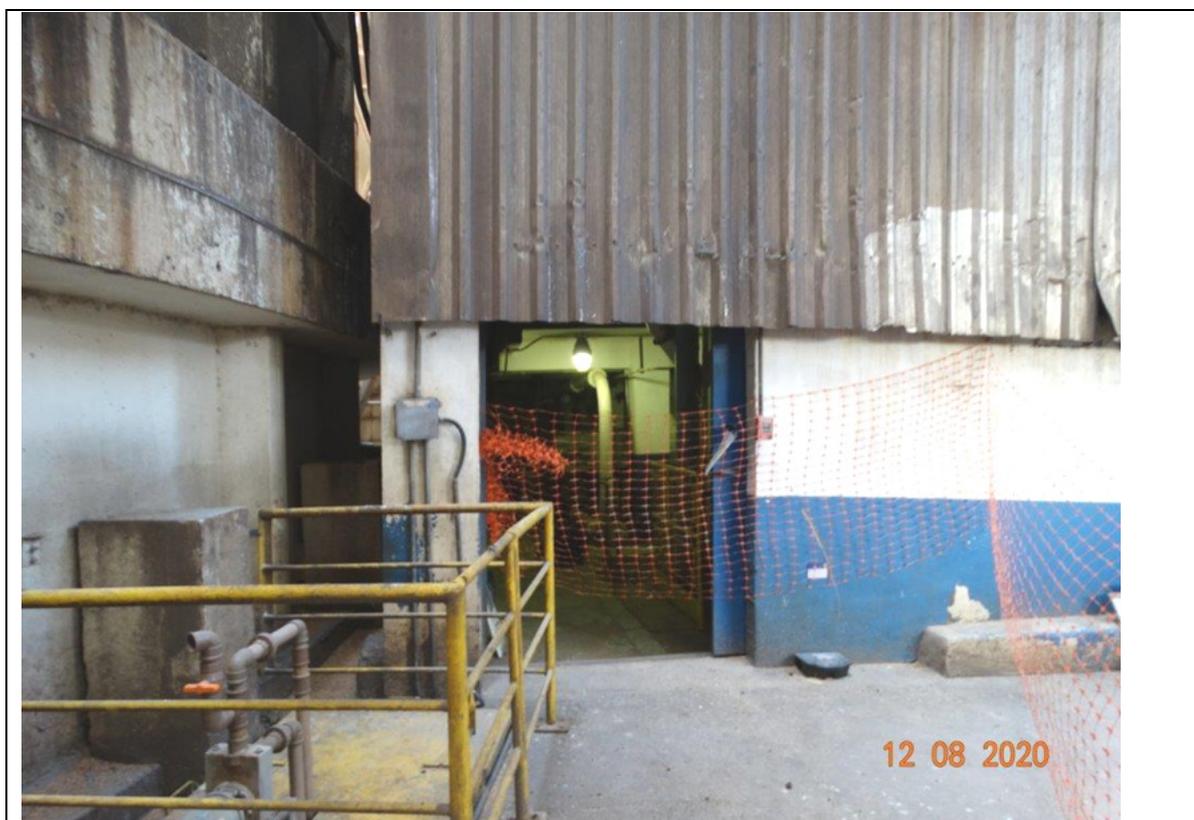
PRÉ-LIMPEZA DO SILO ZORTEA.
